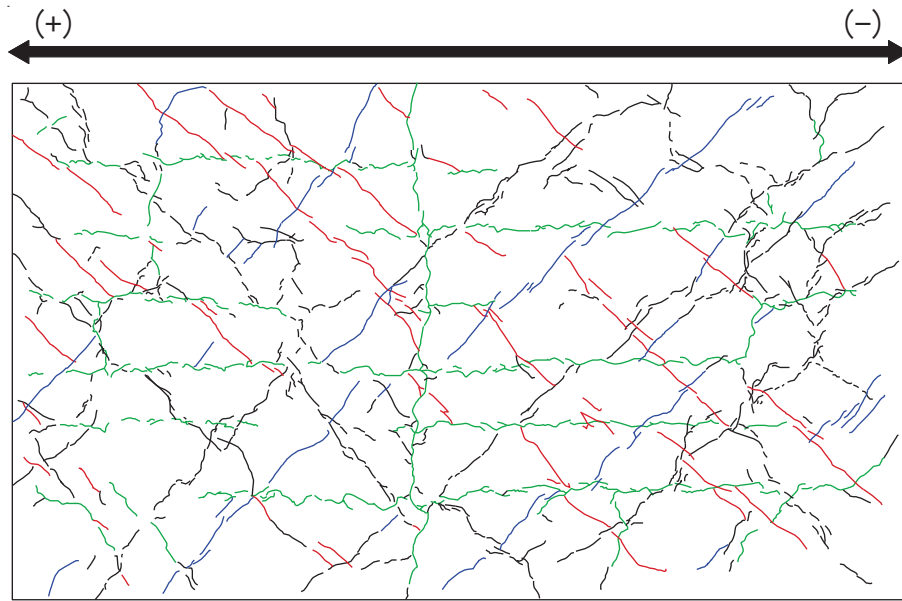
(9) 乾燥試験体 [1] 1/500rad. におけるひび割れ図
